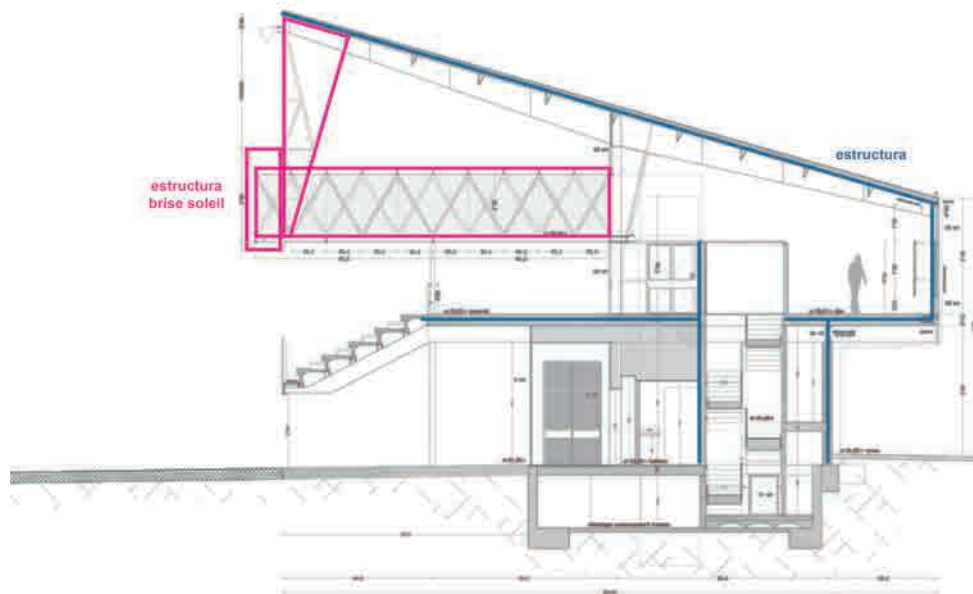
Sistema constructivo. Fuente: <https://divisare.com>. Elaboración: Autores.
